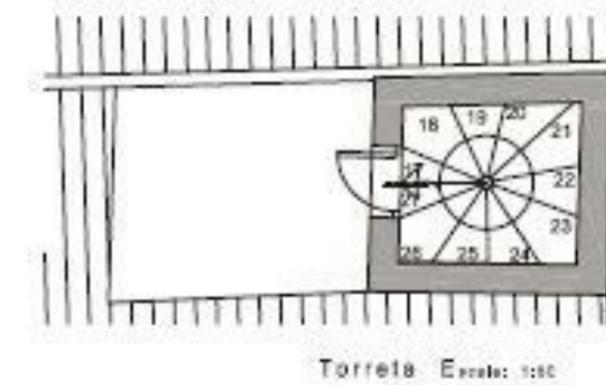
Planta cubiertas 4º desembarco escalera de caracol Fuente: Propia
